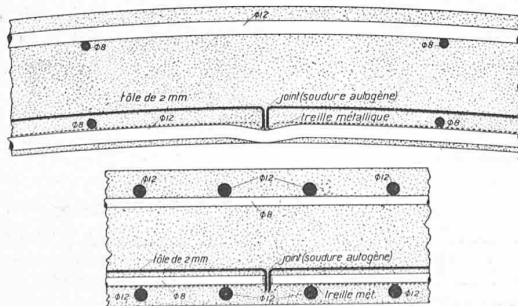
et 6. Coupe en travers et Coupe en long, échelle 1:6, d'un joint de deux panneaux de la partie tôlée.
